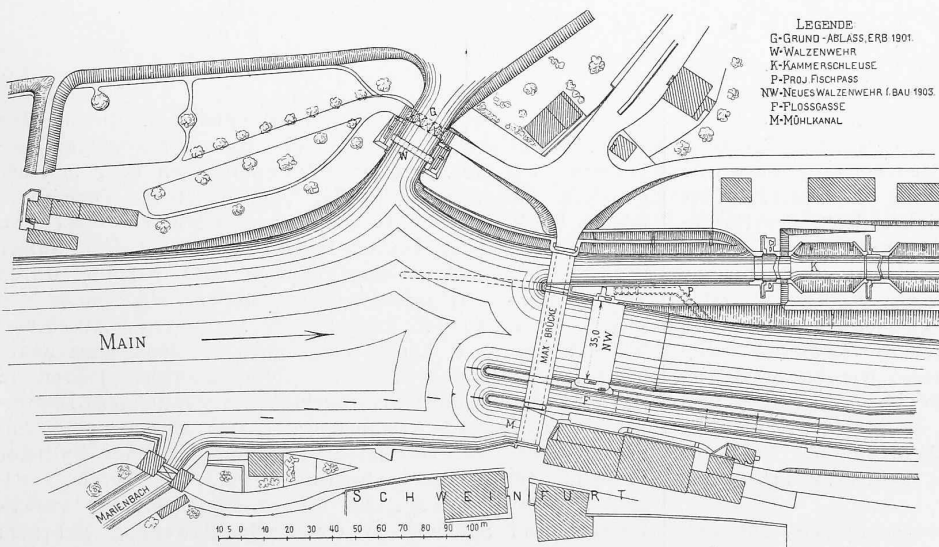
Lageplan der beiden Walzenwehranlagen im Main bei Schweinfurt. — 1:3000.
